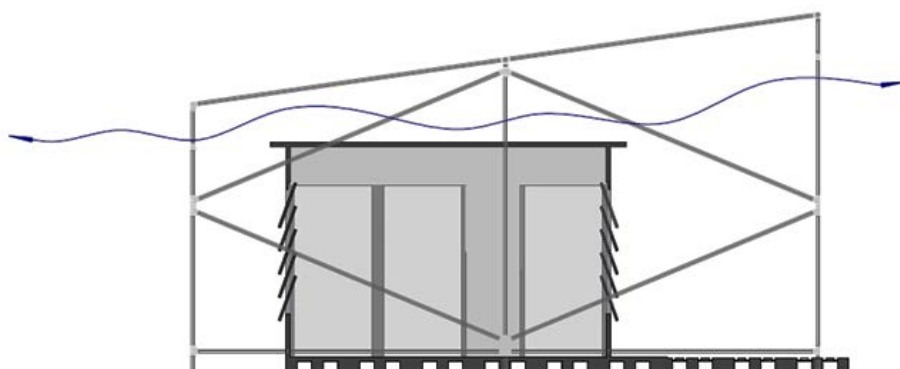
Alzado lateral con la estructura exterior y la simulación de ventilación.
